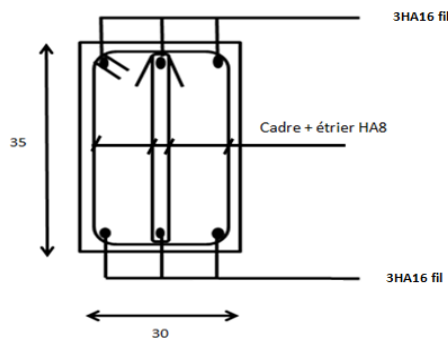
Ferrailage sur appuis d'une poutre principale.
